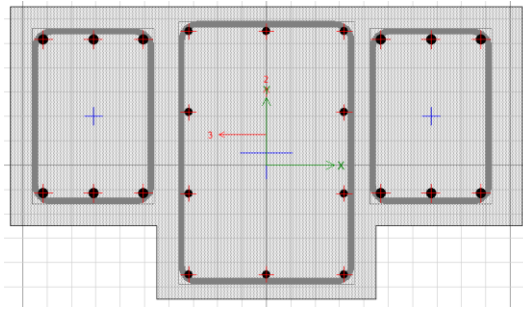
Detalle de columna T con 12 varillas de 3/4" y 10 varillas de 5/8"
